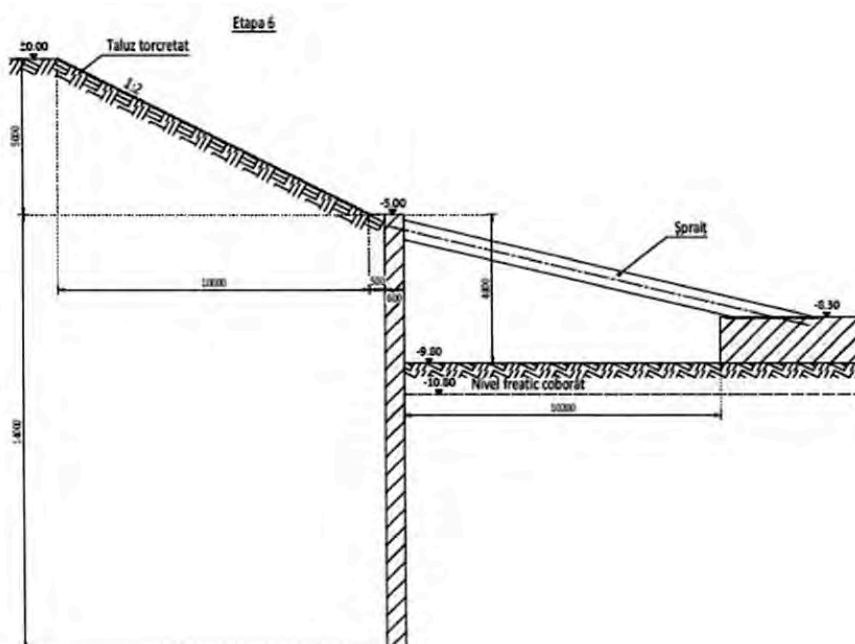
Sectiune faza de executie 9 – faza finala de excavare
